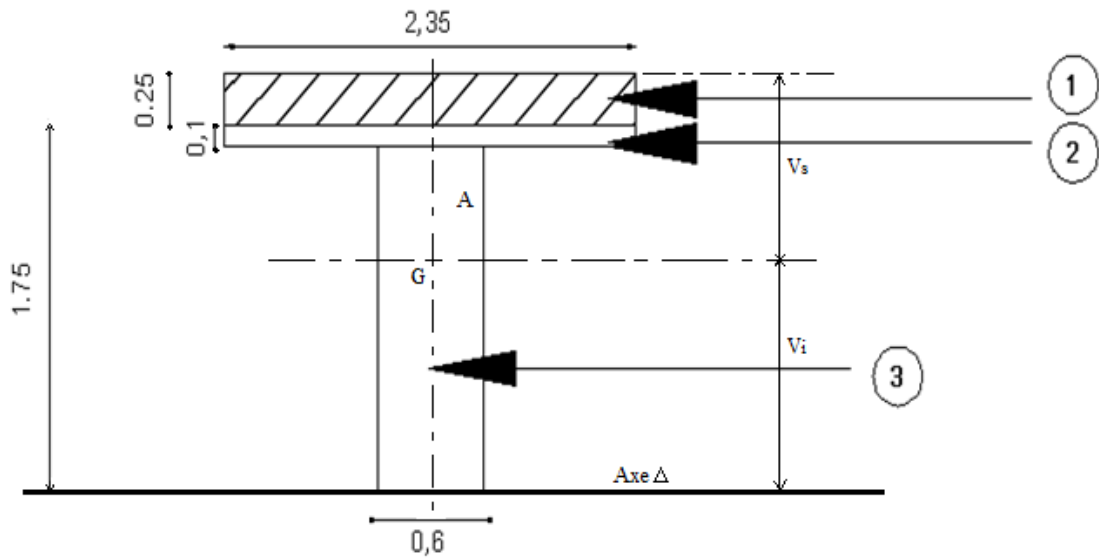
Coupe transversale de la poutre en T et de la dalle.
